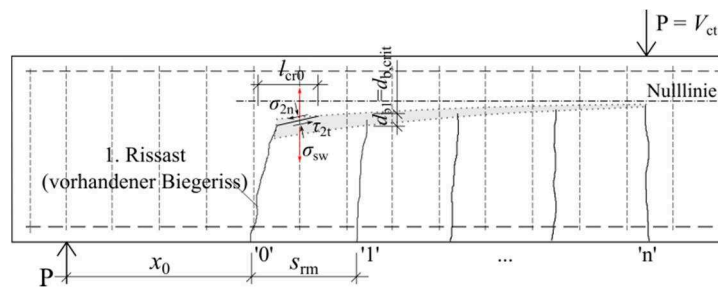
Rissbildung bei Balken mit Querkraftbewehrung
